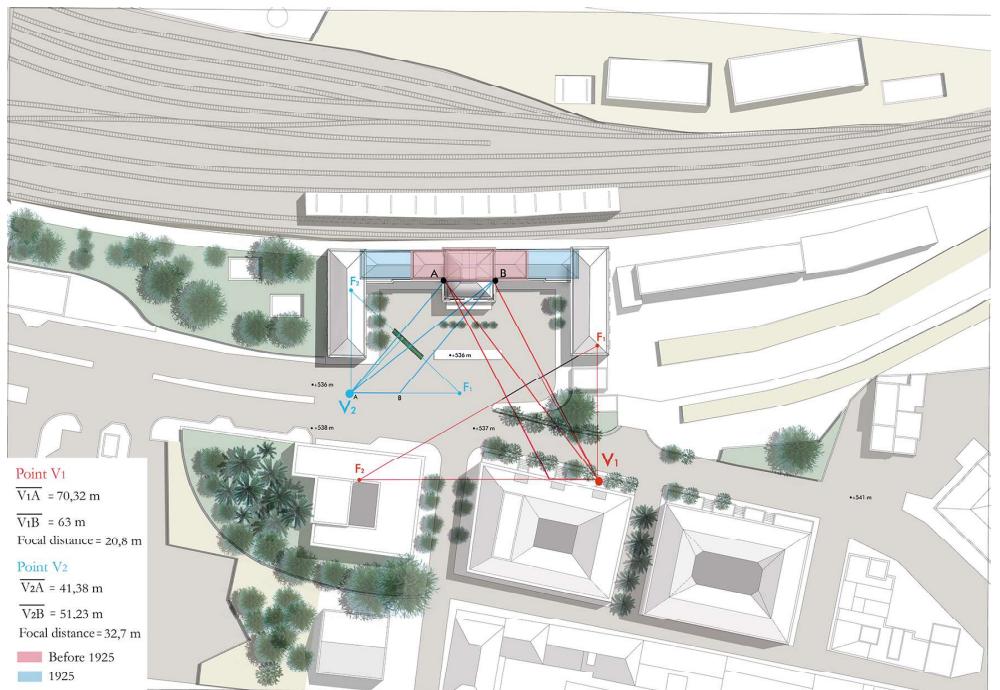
Planimetria della stazione di Caltanissetta Centrale e punti di presa delle foto d'epoca. Archivio autori.
